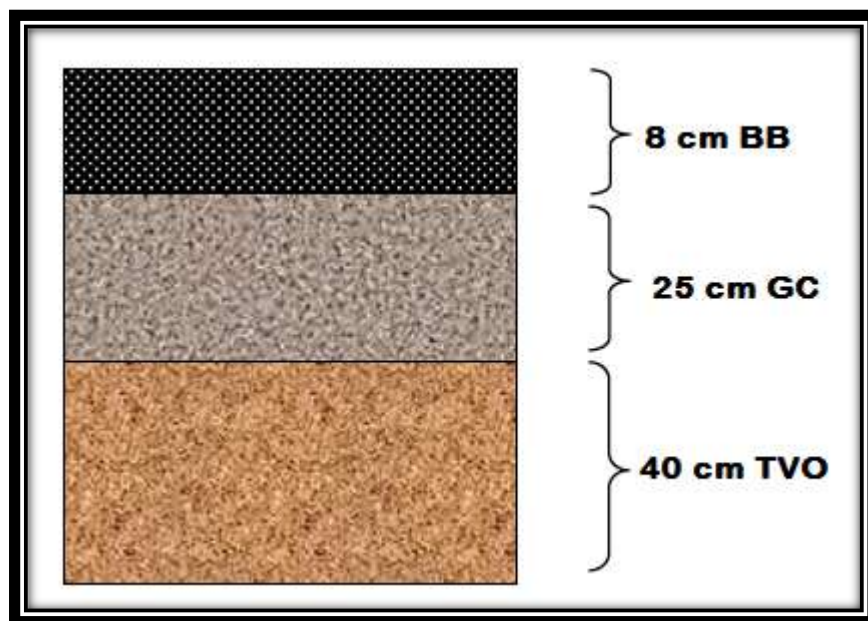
Différentes couches du corps de chaussée de la variante choisie
